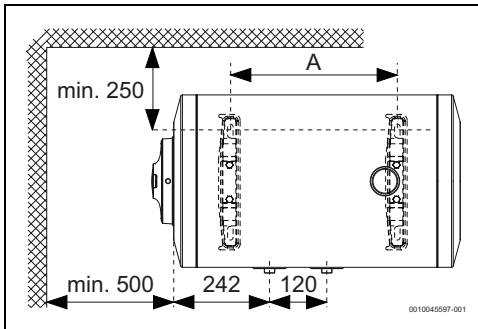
Dimensions en mm (montage mural, installation horizontale, TR1000...H)
